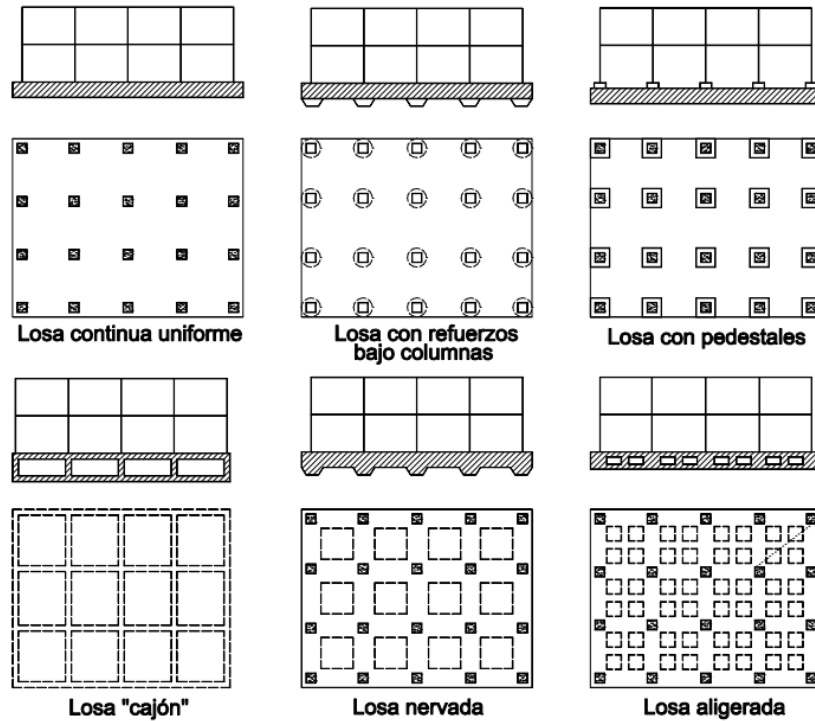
Tipología de losas de cimentación, Fuente CTE BD SE-C
